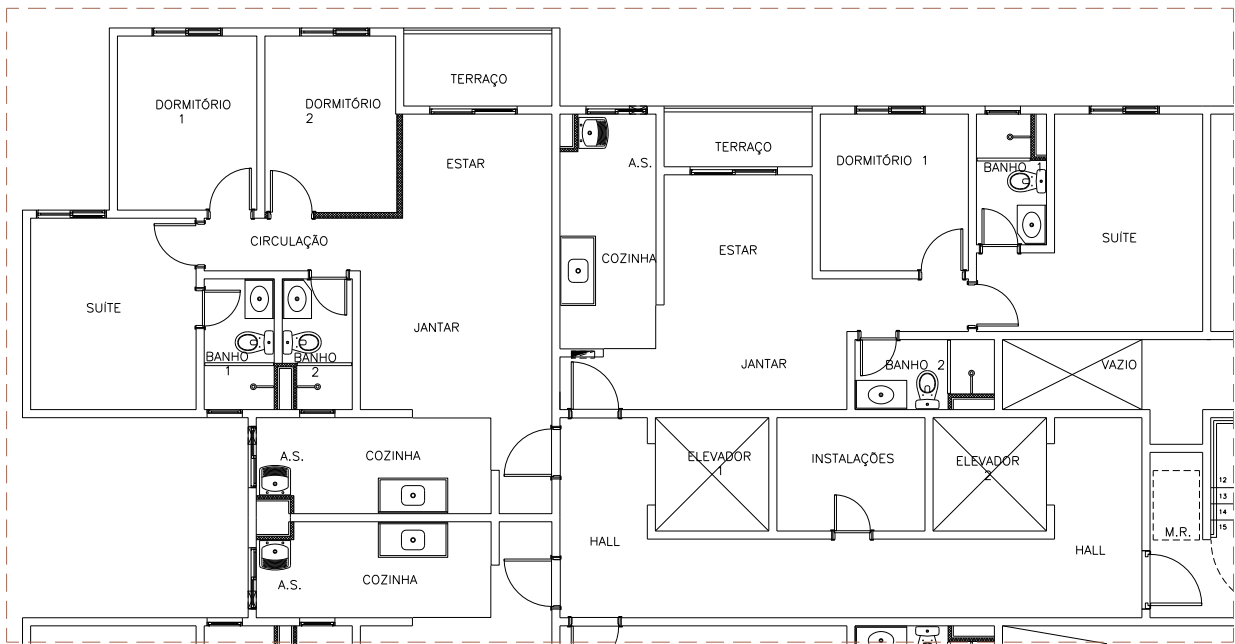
Edifício Vita Belle: detalhe da planta arquitetônica
